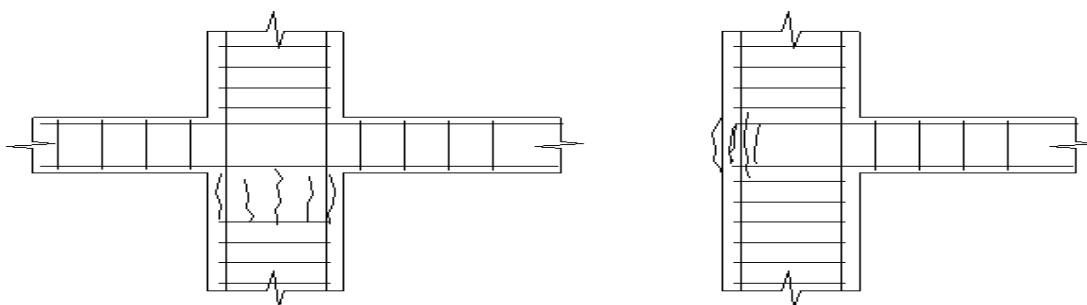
Fissuras causadas por falta de estribos. Fonte: THOMAZ, 1989.
